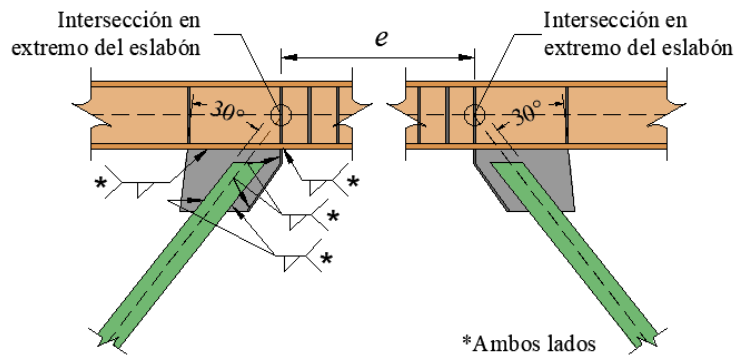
Soldaduras de diagonales a la viga
